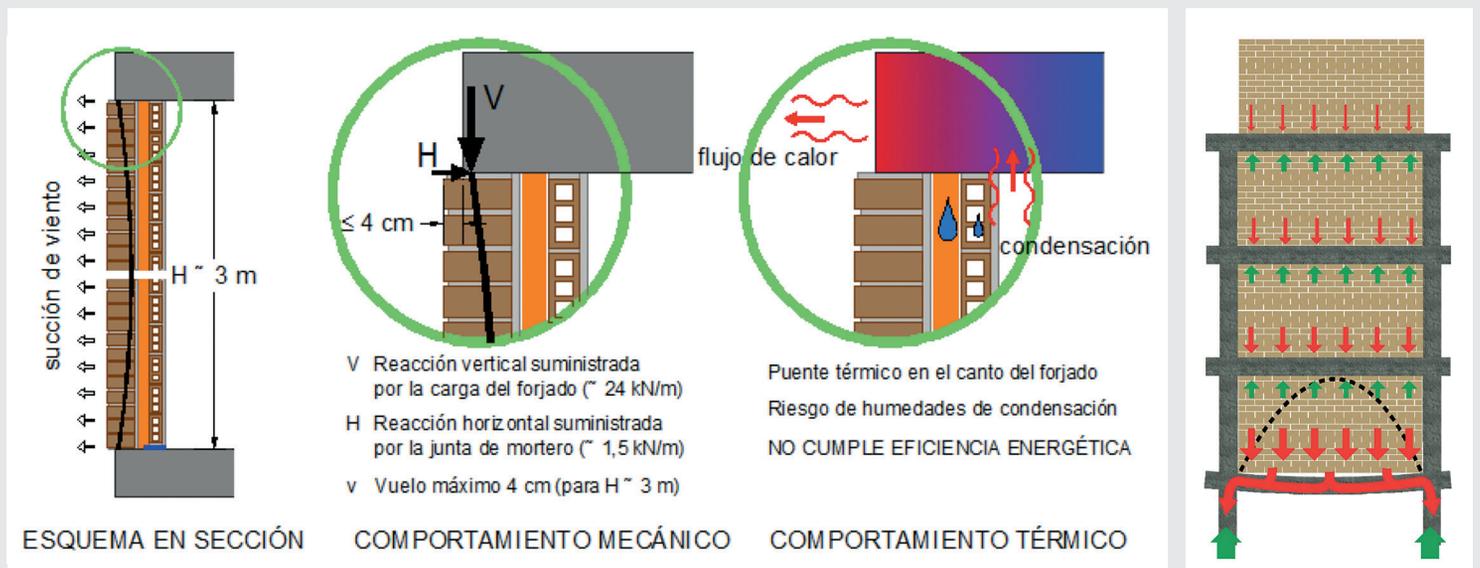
Fachada de ladrillo cara vista confinada entre forjados (sistema convencional)
